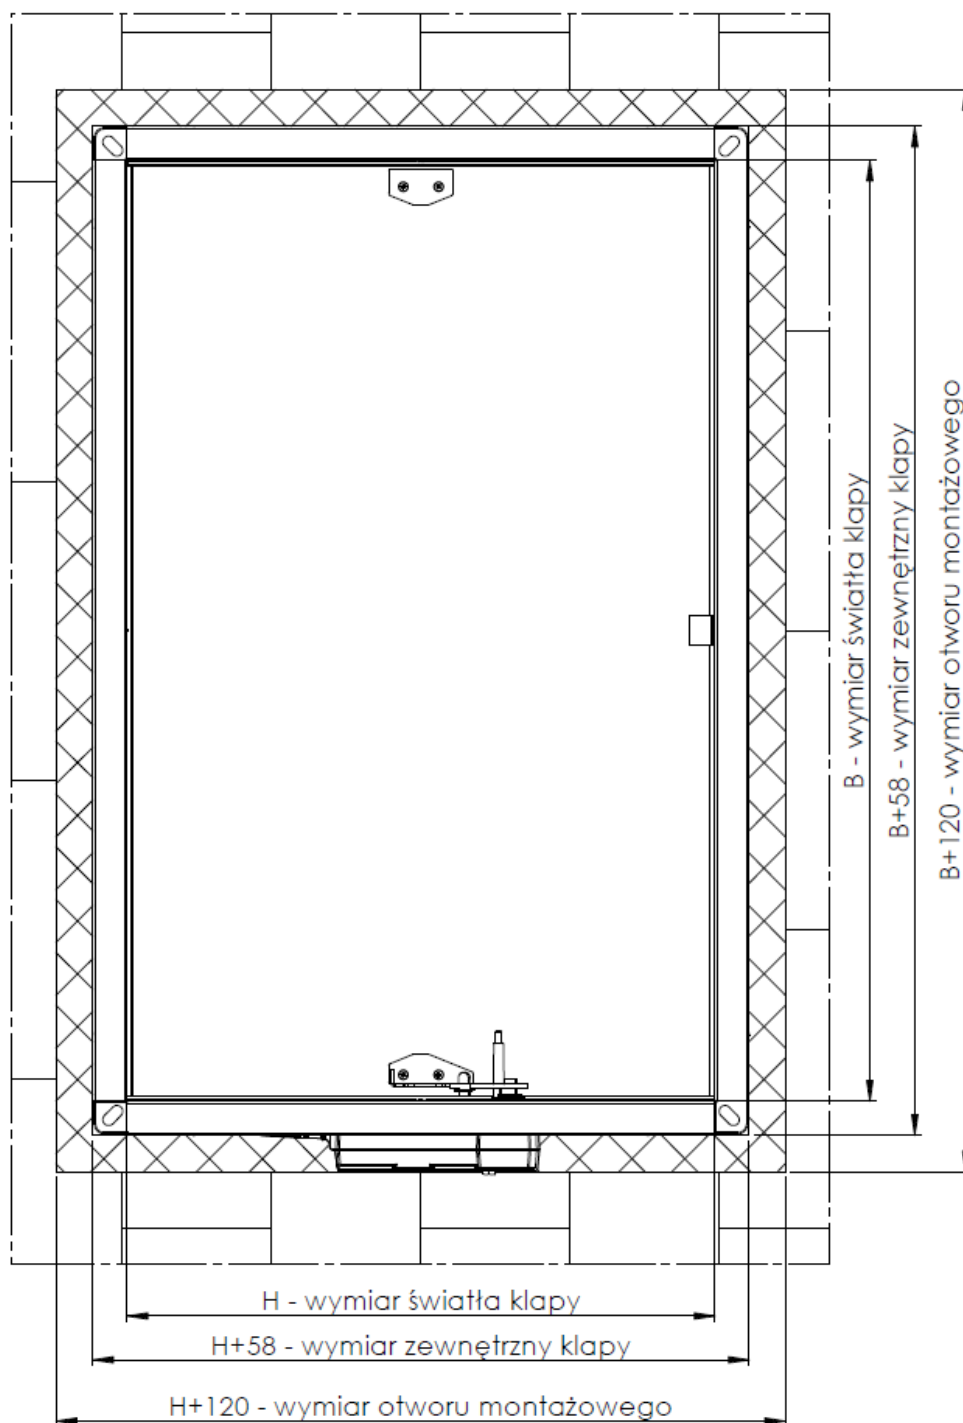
Sposób zabudowy kłap odcinających KWP-L w konstrukcjach stropowych
